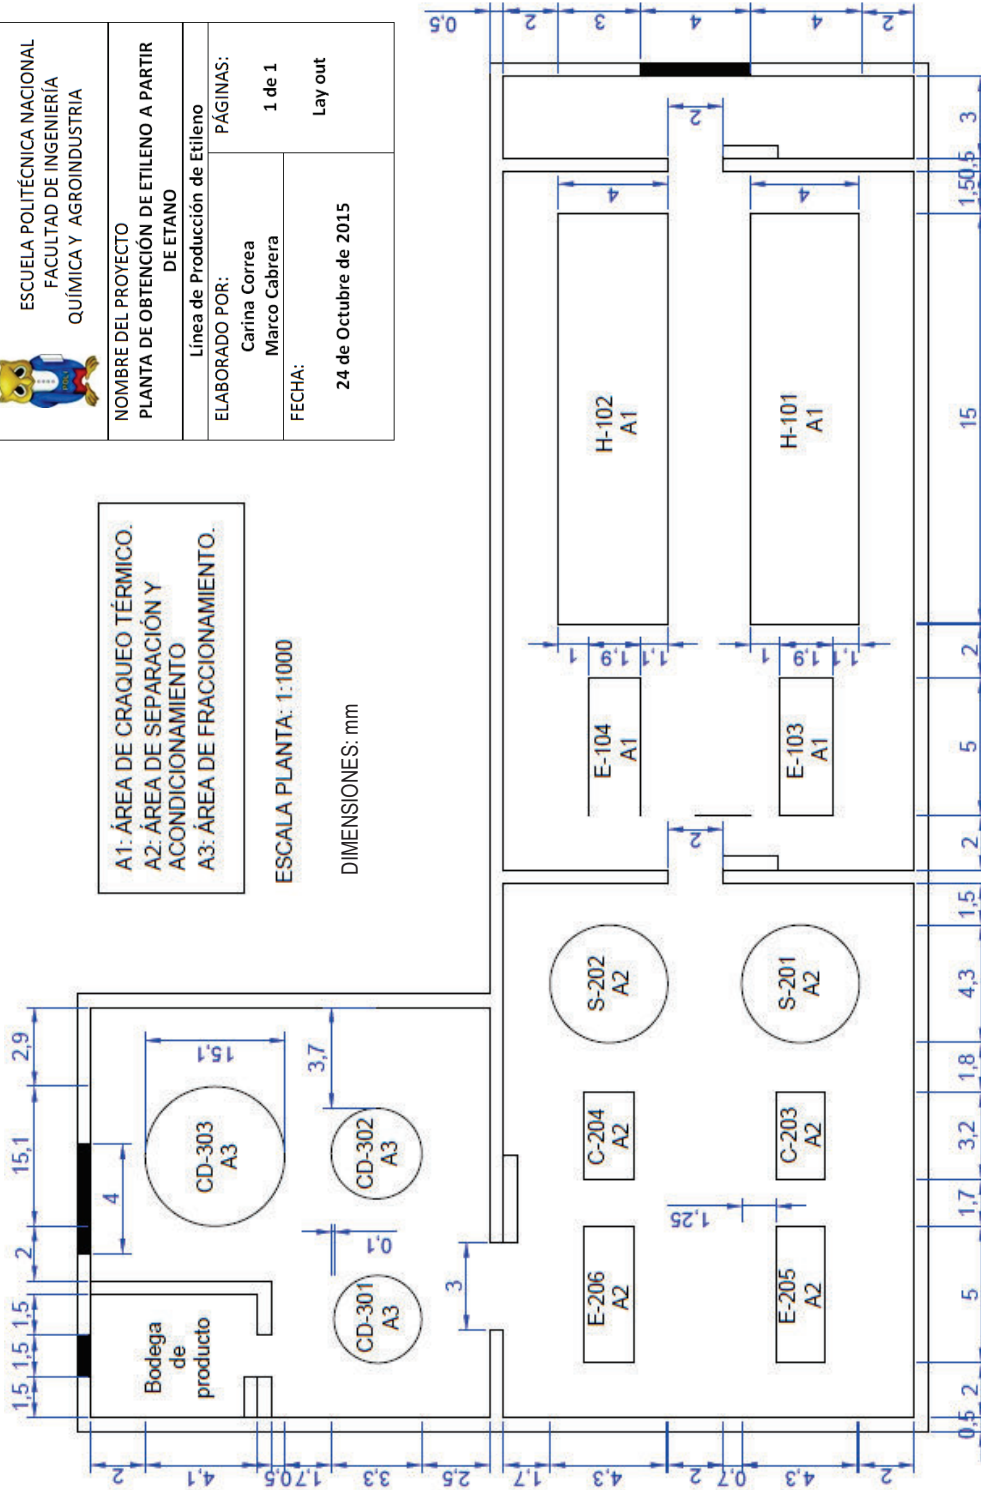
Lay out de la planta de producción de etileno a partir de etano
